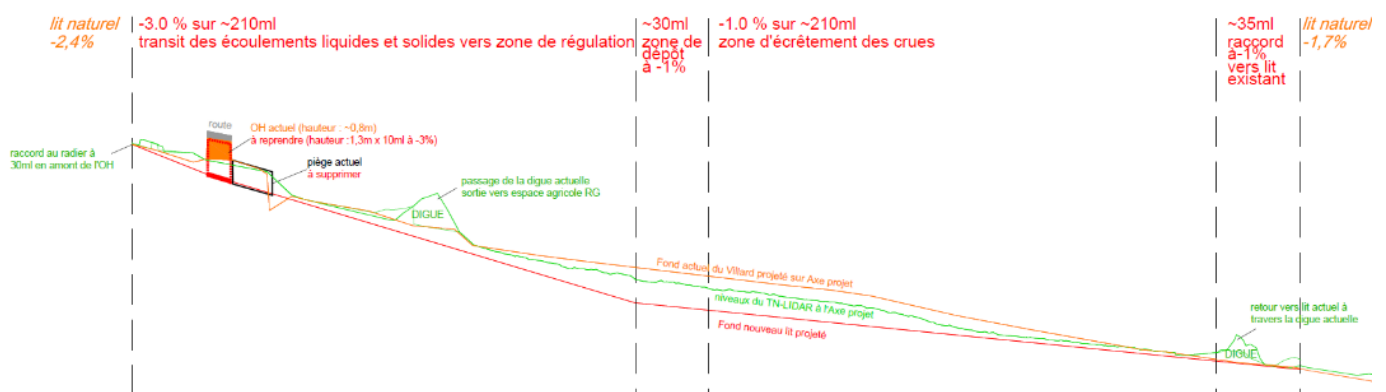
Profil en long projeté du ruisseau du Villard sur le secteur de Tavan
